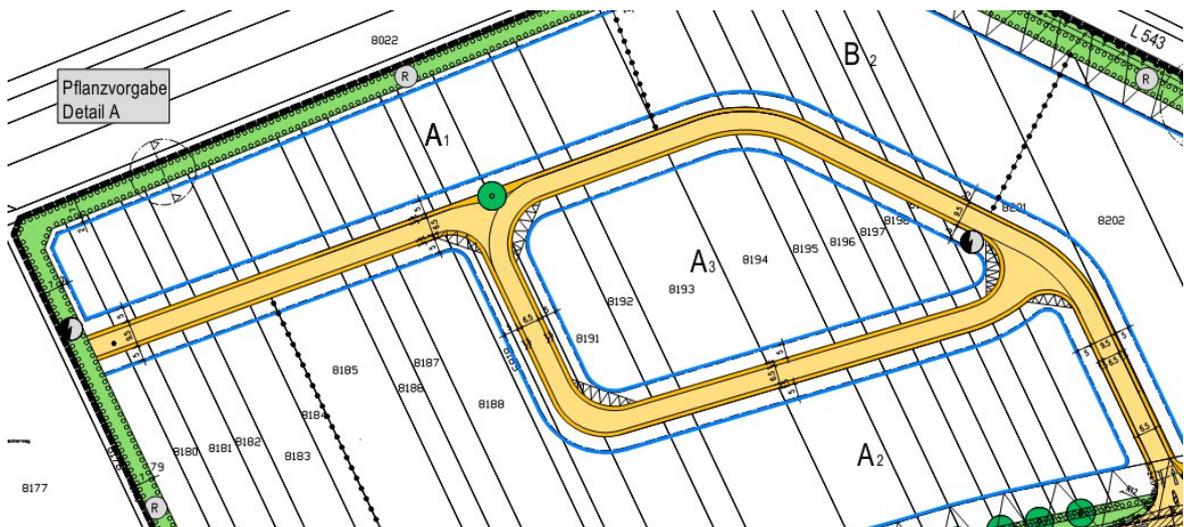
Planausschnitt 1. Änderung (Verkleinerung des Erschließungsringes und Wegfall der Grünfläche am westlichen Ende der Erschließungsstraße)
